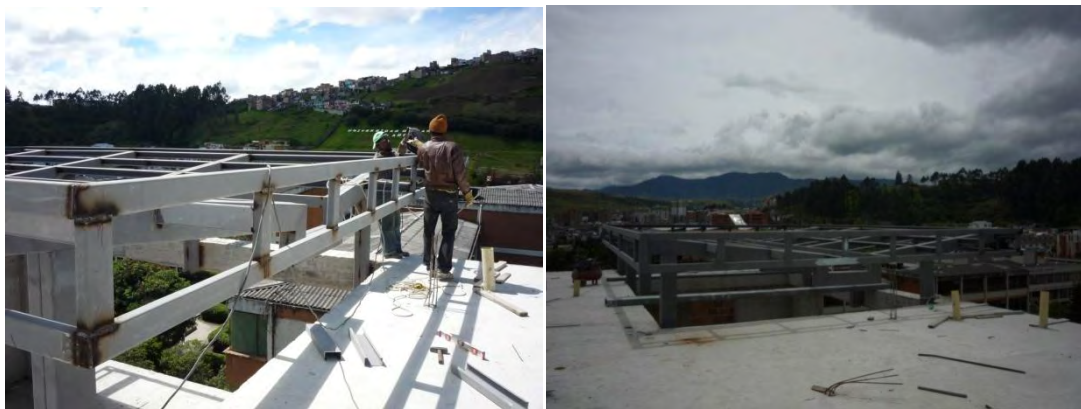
Instalación de Platinas base cubierta 340x280x9mm incluye 6 anclajes 5/8"
